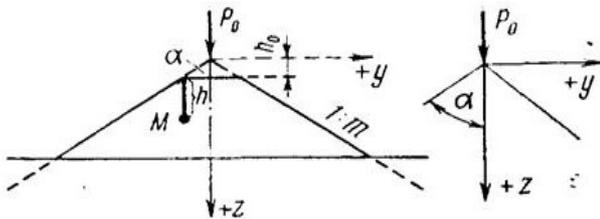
Расчет напряжений в грунтах насыпи по схеме упругого клина
